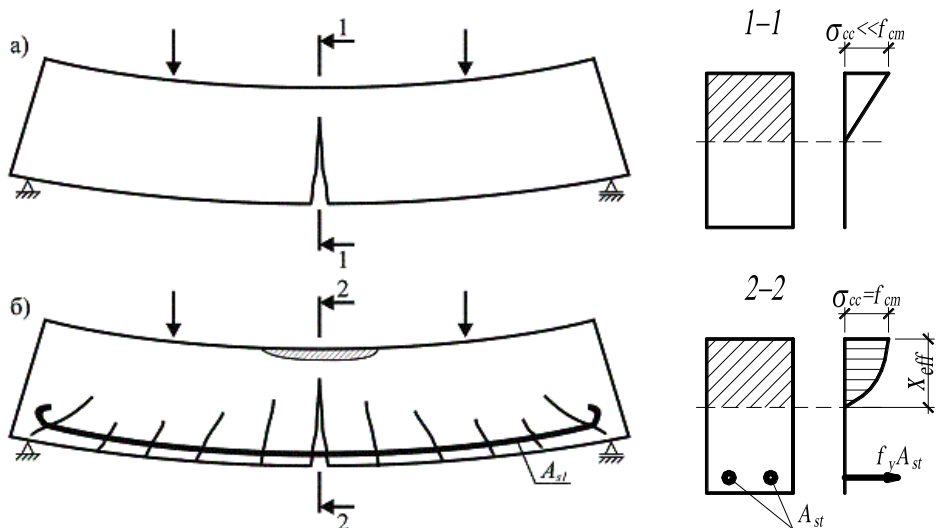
Характер образования трещин и разрушения бетонной (а) и железобетонной (б) балок
